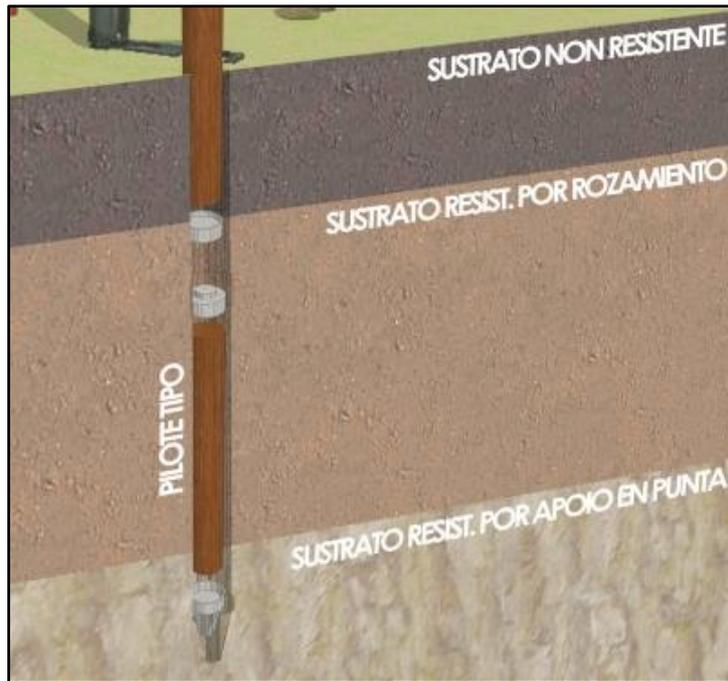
Cimentación con pilotes de madera.<sup>83</sup>
